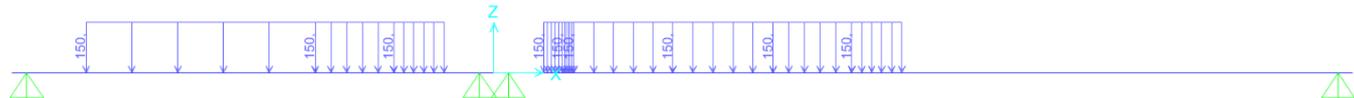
disposizione di carico 6 - SW/2 – pila 1
